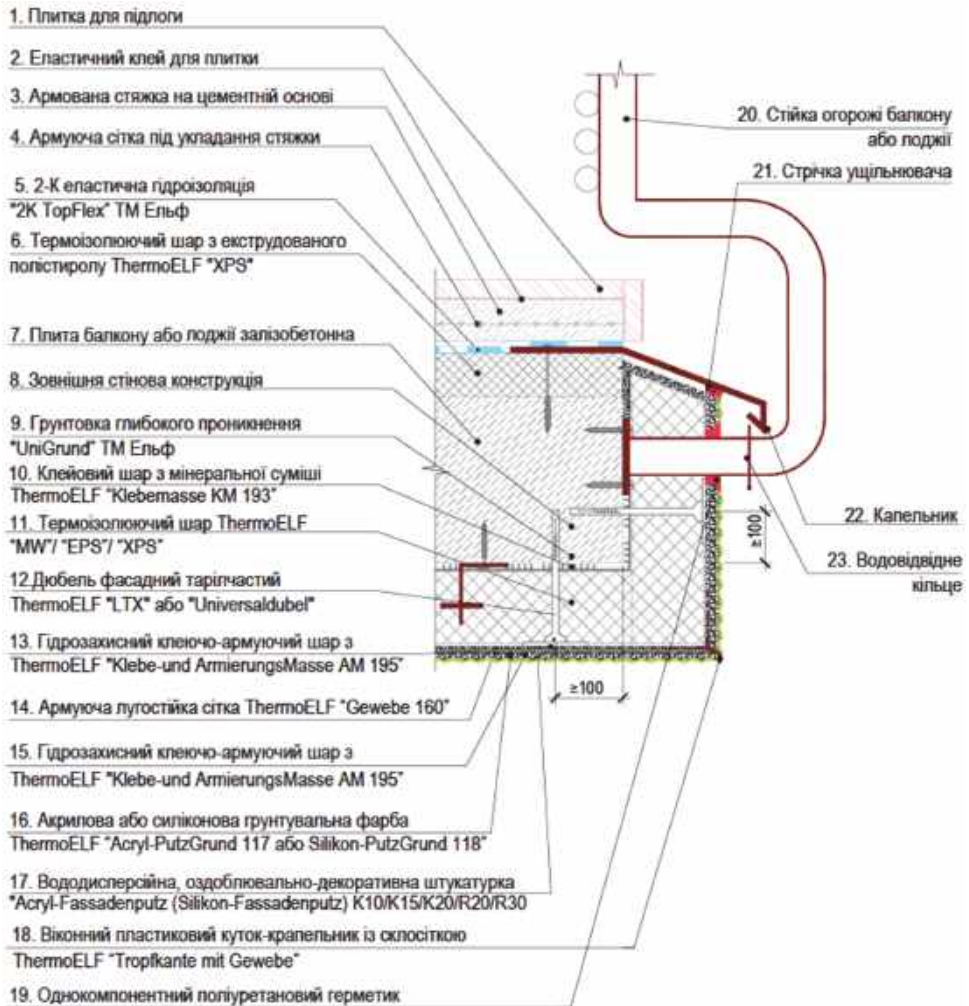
Вузол 14. Улаштування системи теплоізоляції по залізобетонній плиті балкона або лоджії
